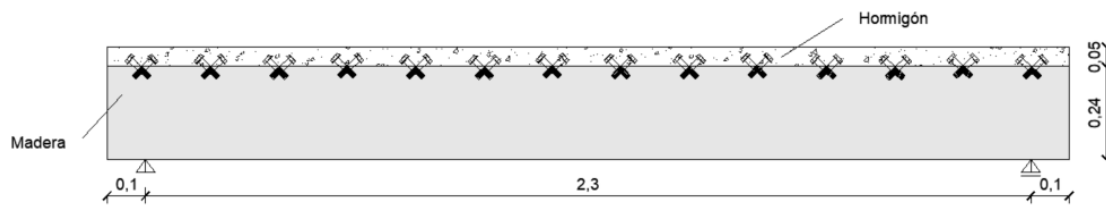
Corte longitudinal de la viga. Unidades: metros.
